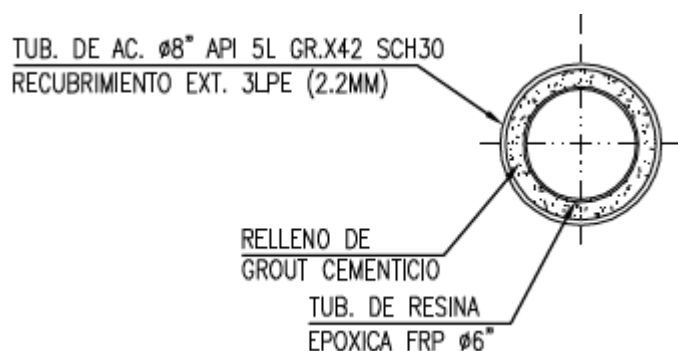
Sistema de tuberías de paredes múltiples tamaño 6"x 8"
